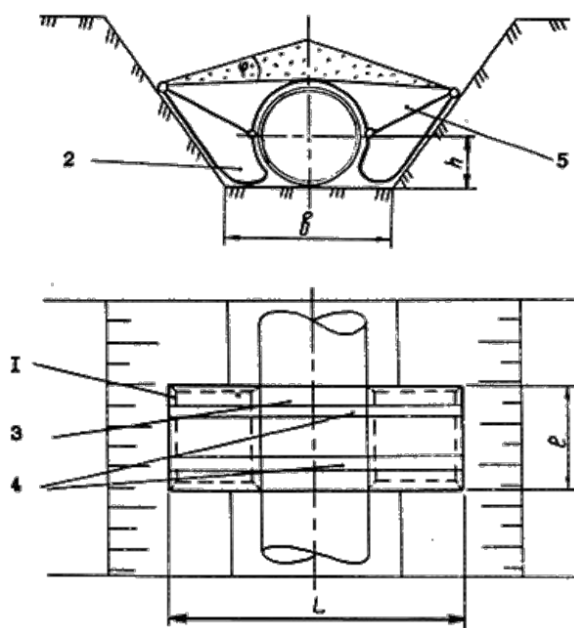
Схема конструкции полимерно-контейнерного балластирующего устройства: 1 - рамка жесткости; 2 - емкость из мягкой ткани; 3 – нижняя грузовая лента; 4- верхняя грузовая лента; 5 - противоразрывная перегородка
